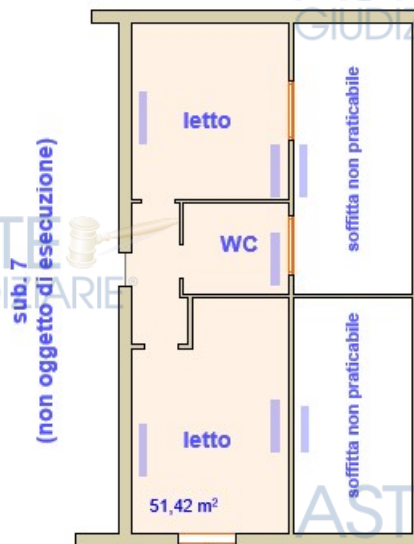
Planimetria di rilievo locali mansarda (Fig. 10 P.IIa 544 sub 8)
